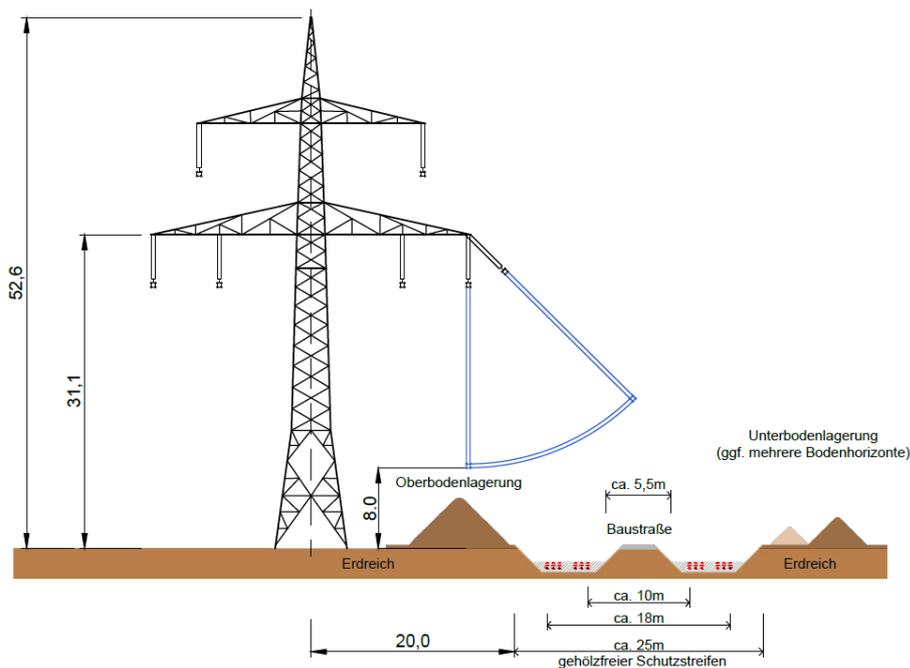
Parallelführung 380-kV-mit Erdkabeltrasse mit einer bestehenden Freileitung (alle Maße in m)
